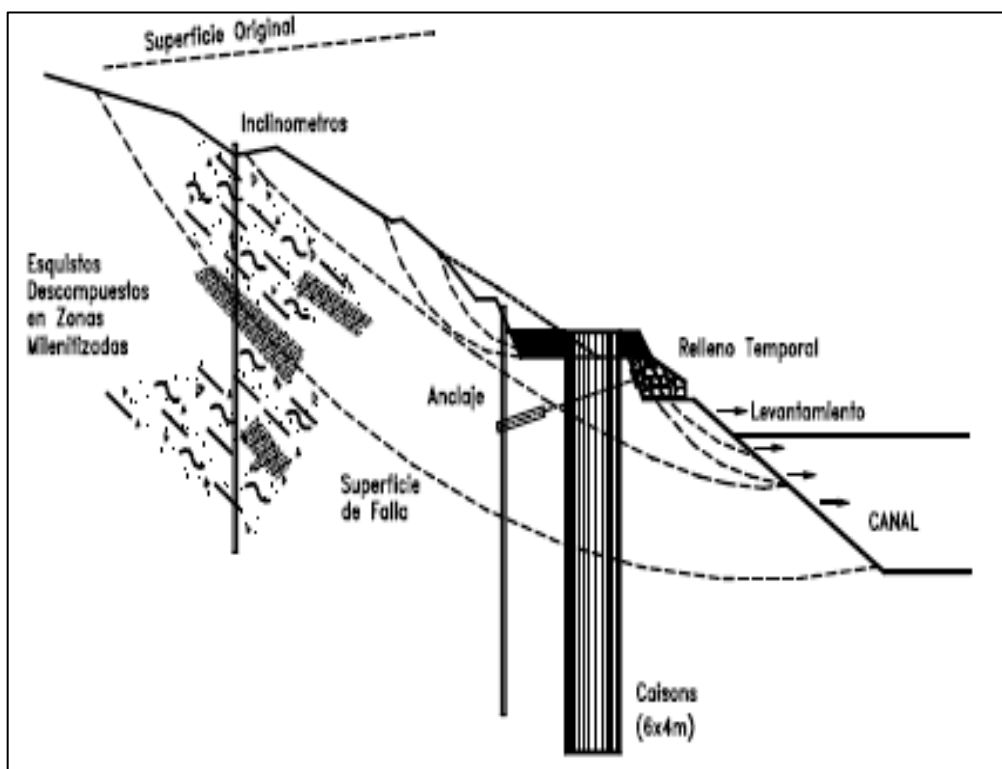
Colocación de Pilotes para la estabilización del talud vertical.
